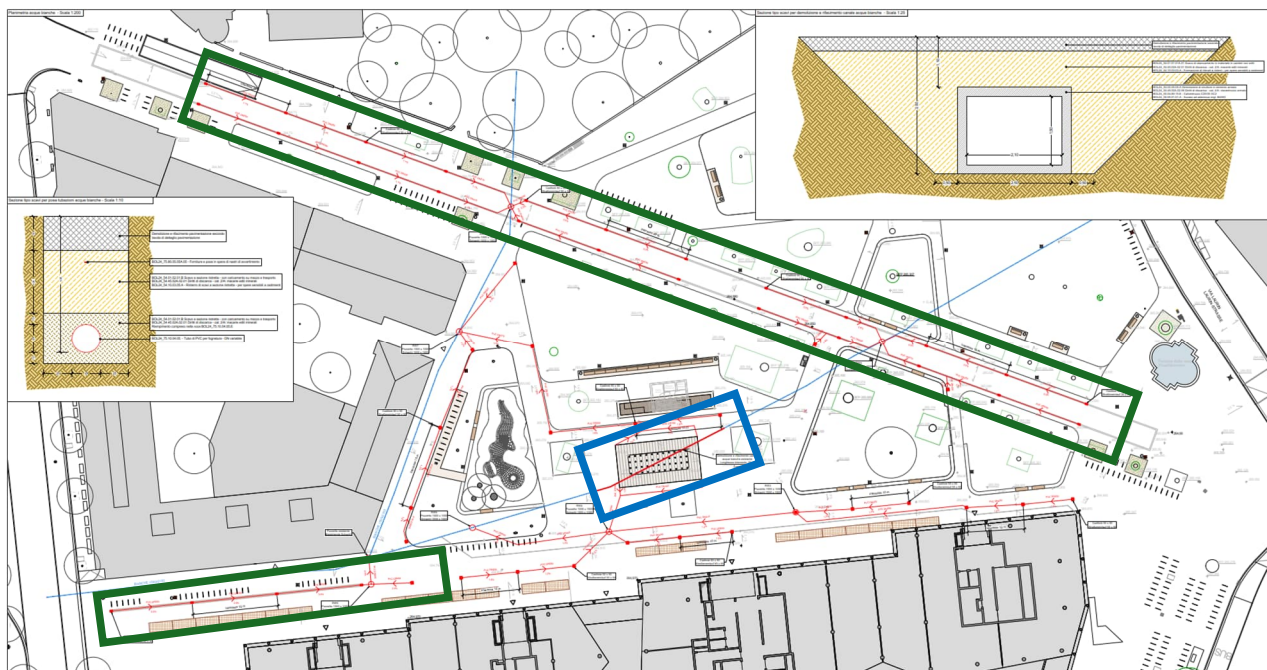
Planimetria della nuova rete di drenaggio delle acque bianche - estratto della tavola D.01.08. In verde sono evidenziate le aree in cui è prevista la posa di caditoie di dimensione 30 x 50 cm, mentre in blu il tracciato in cui è prevista la demolizione ed il successivo rifacimento del canale esistente.
